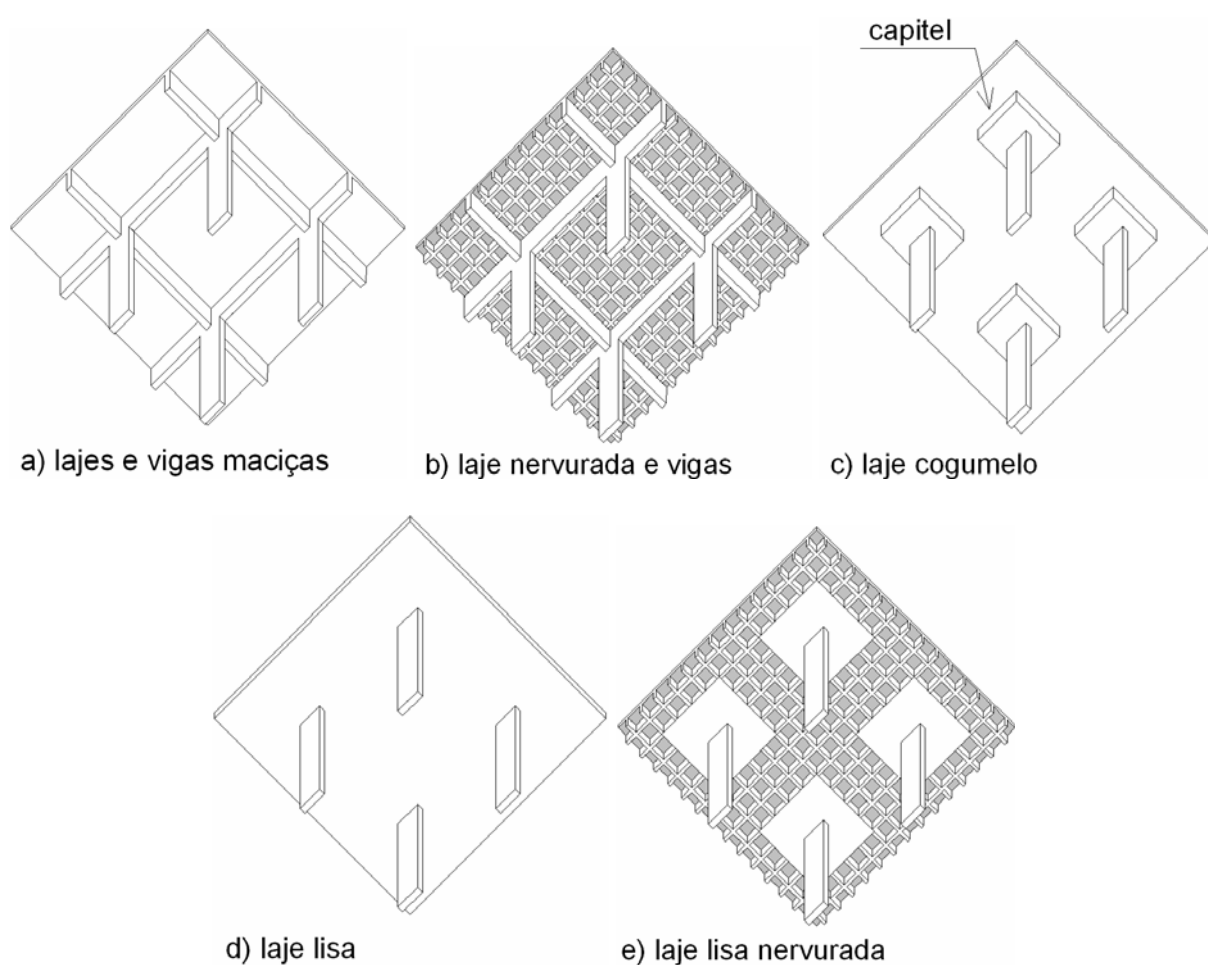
Sistemas estruturais com lajes em concreto armado
